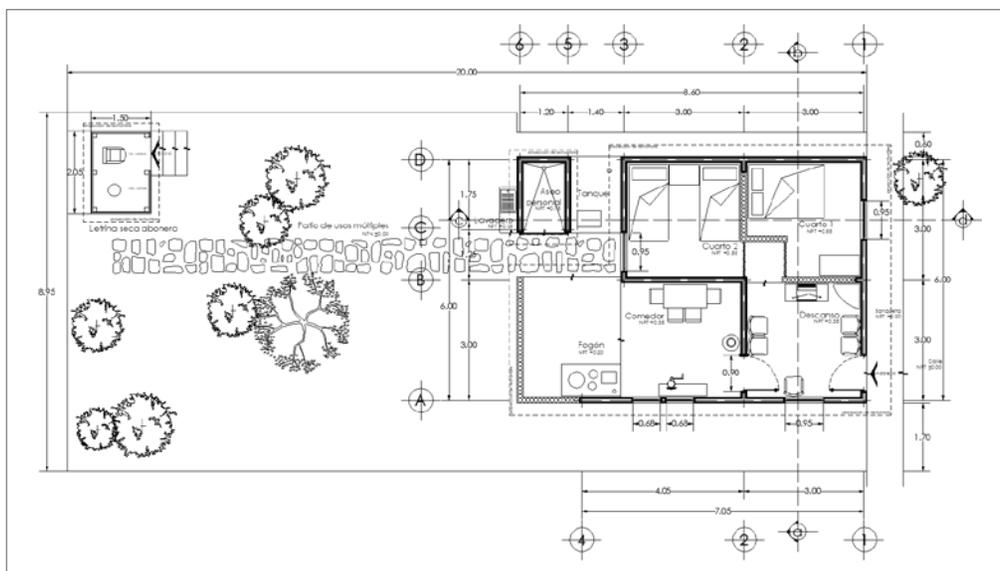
Planta arquitectónica de un prototipo de vivienda rural (Escamiroso et al., 2011)
